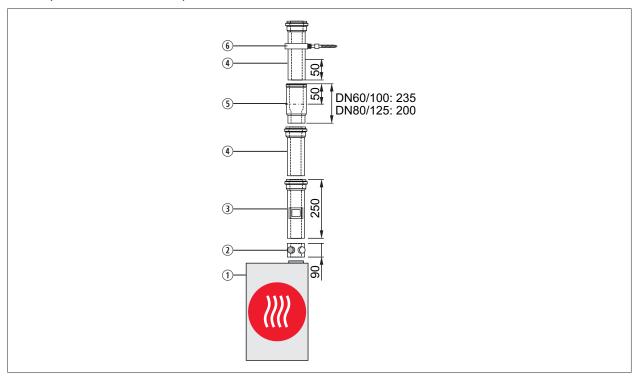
Exemple de conduit d'air / des fumées [mm]
